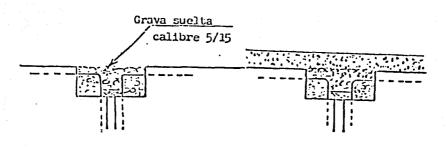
DETALLE TIPO DE PREPARACION PARA JUNTA EN LOSA.
